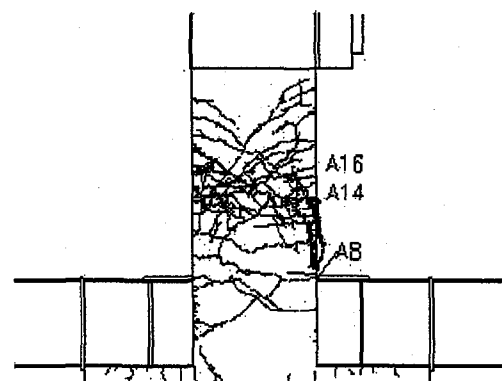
TYPE 1-2 最終時橋脚ひび割れ状況
